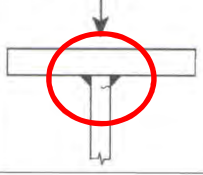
Ausführung der oberen Halsnaht beim I-Schweißprofil
